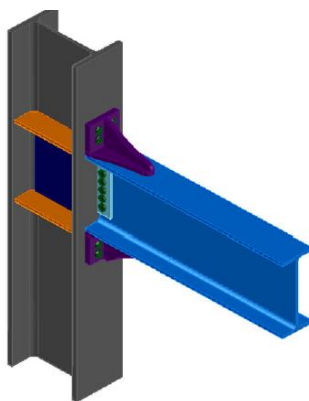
Conexión Kaiser con rigidizador soldado. (Propia, 2012)
